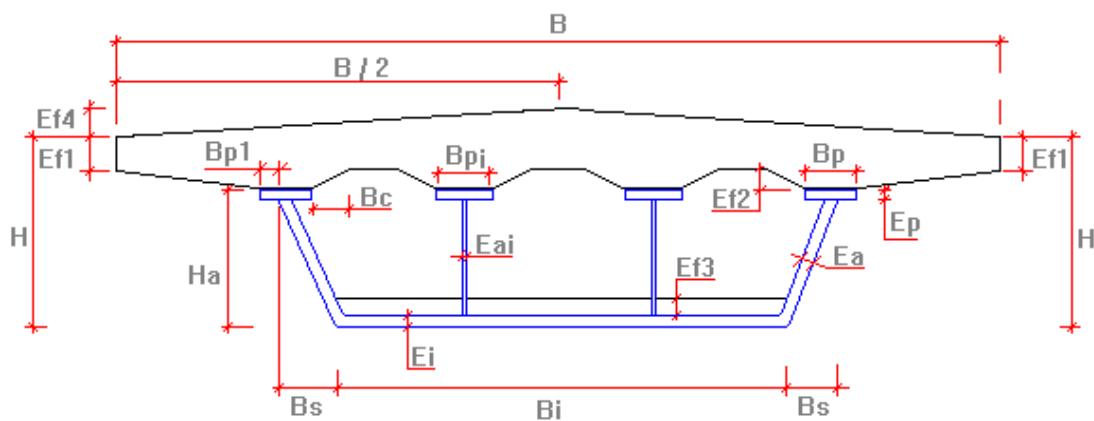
Sección transversal del puente (cajón multicelular abierto).
